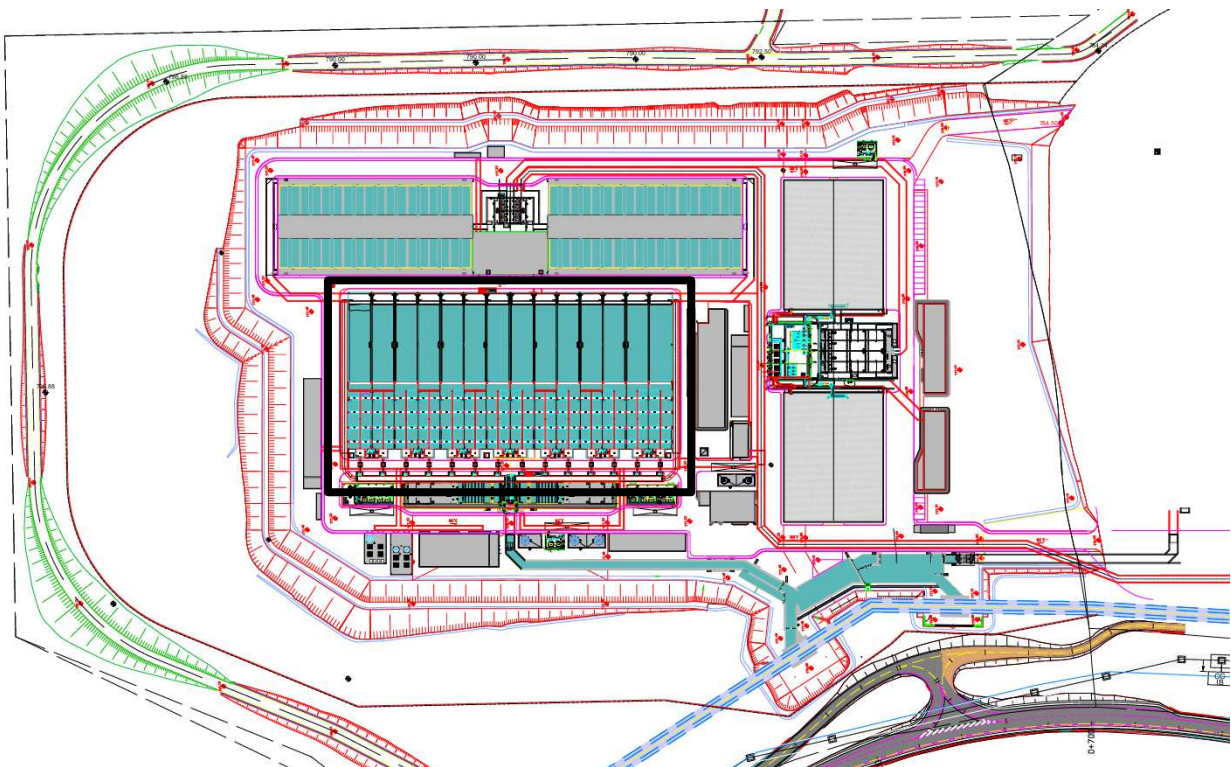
Planta de los decantadores lamelares del proyecto constructivo (indicado en un rectángulo de color negro)
